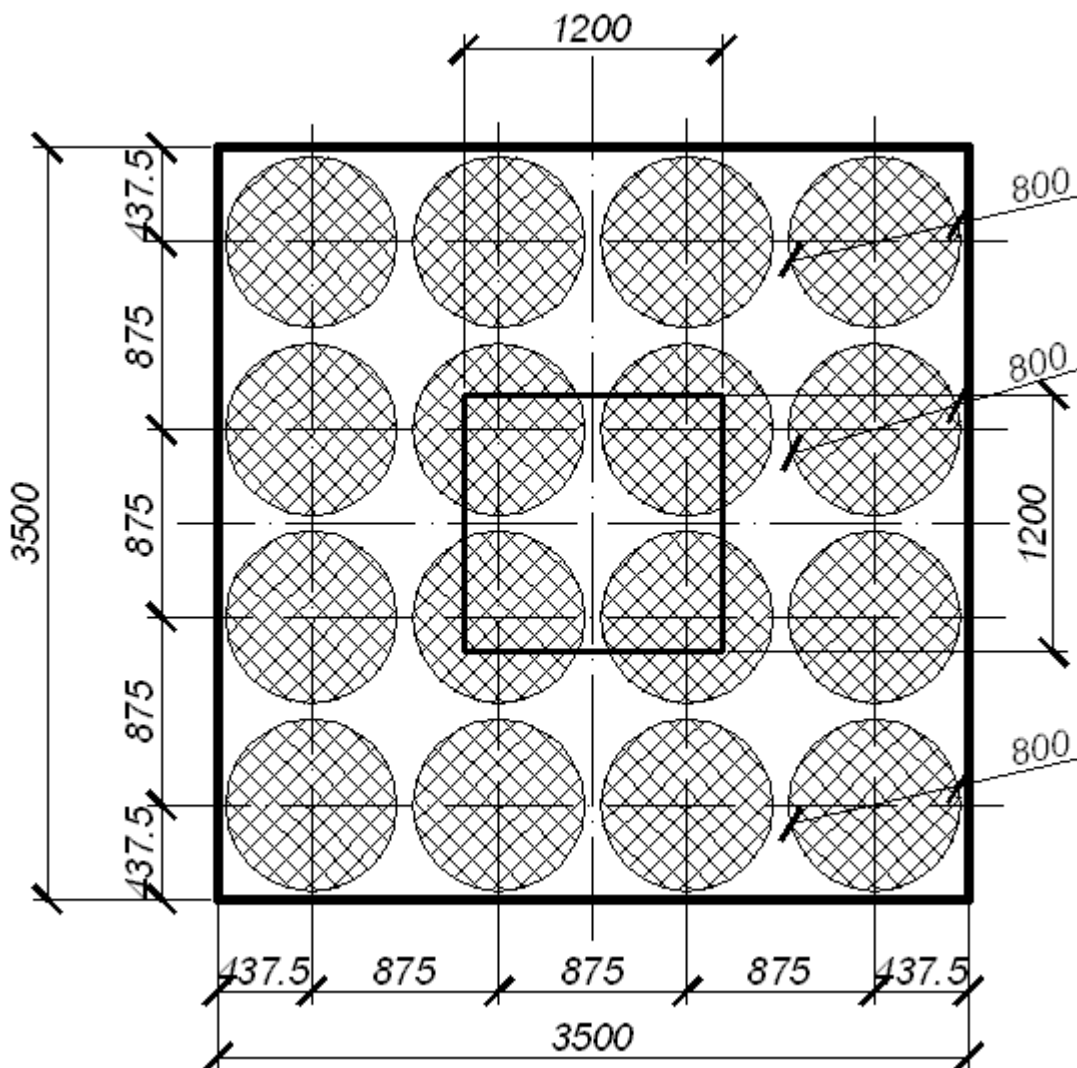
План розташування мікропаль із радіусами закріплення ґрунту основи
